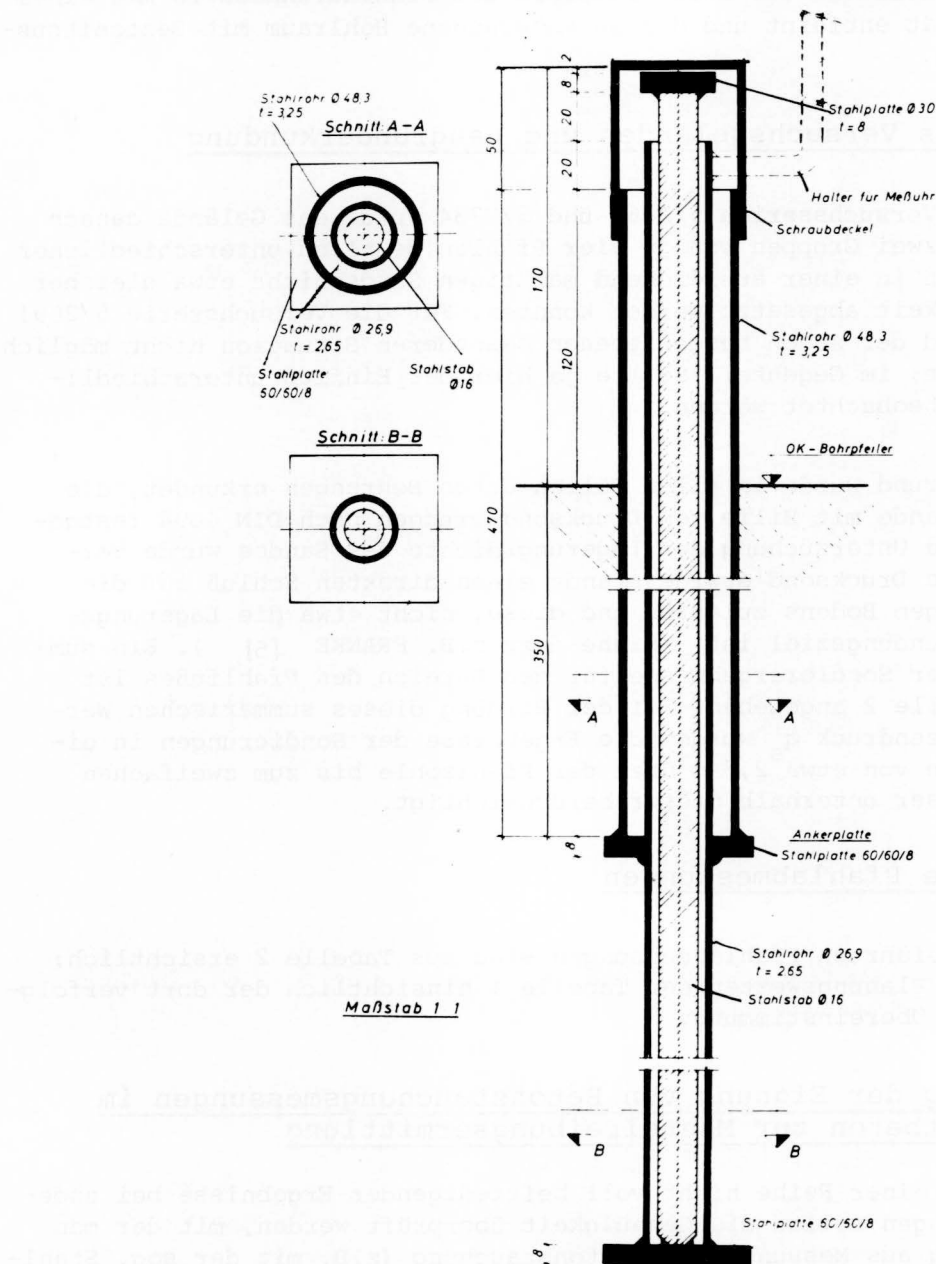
Messung der Betonstauchung im Pfahlschaft mit Stahlstäben
